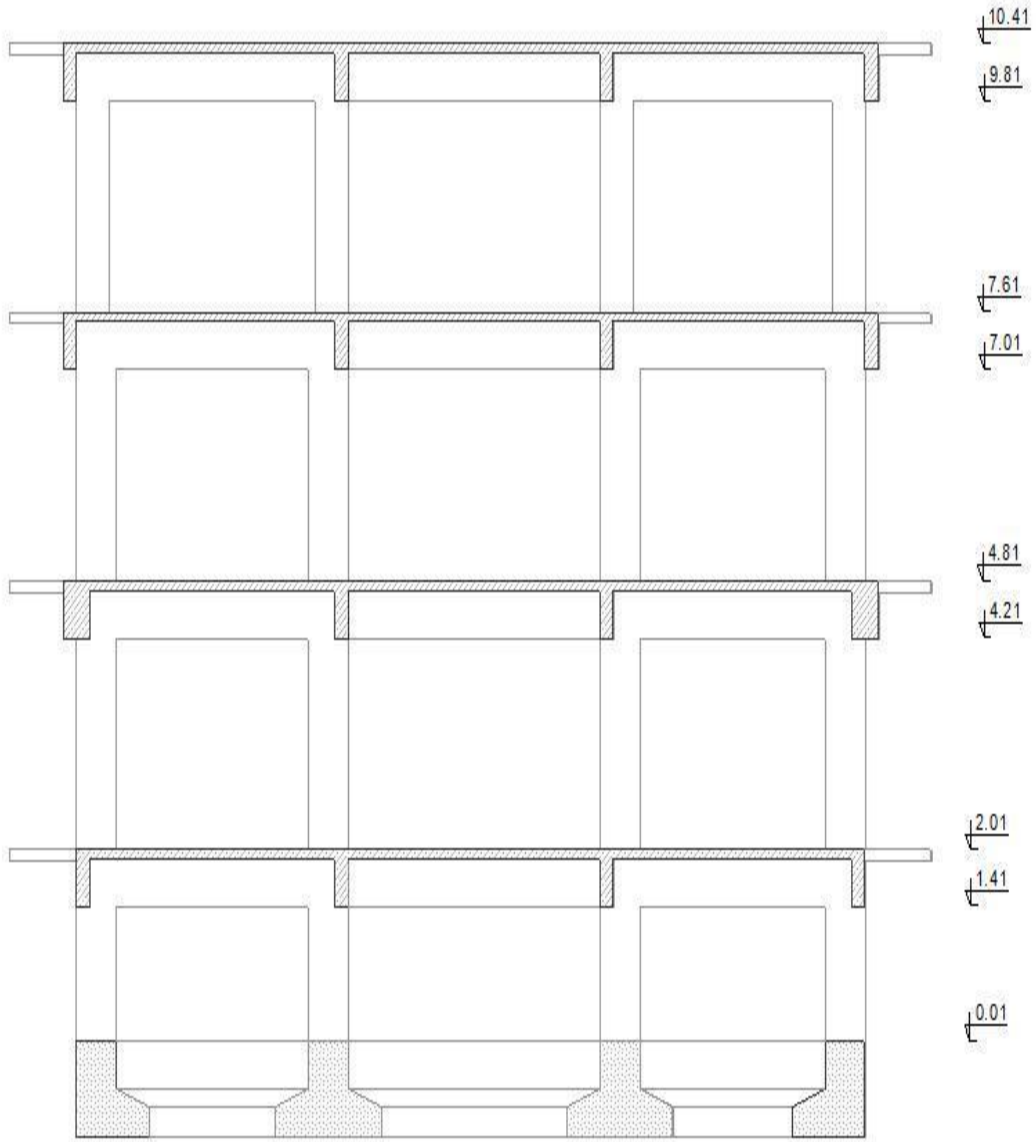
Tip 1 Uygulamasında Bina Planı
